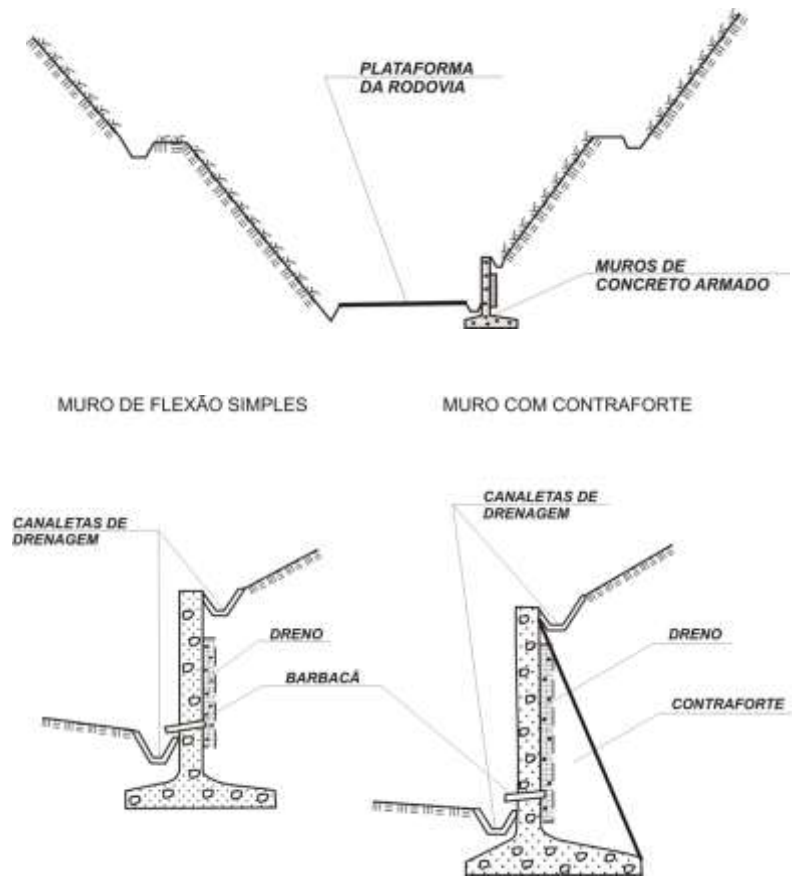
Projeto tipo 15 – Muro de concreto armado.
